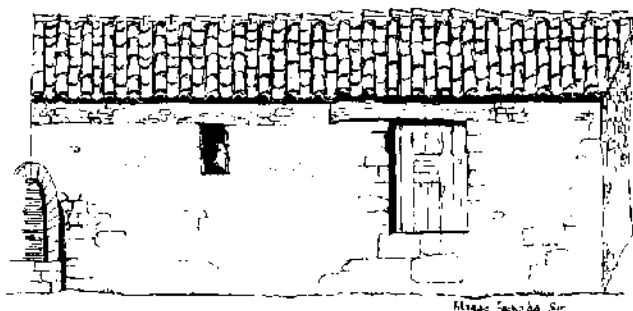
Alzado de la fachada del sur, donde está la puerta de entrada.
